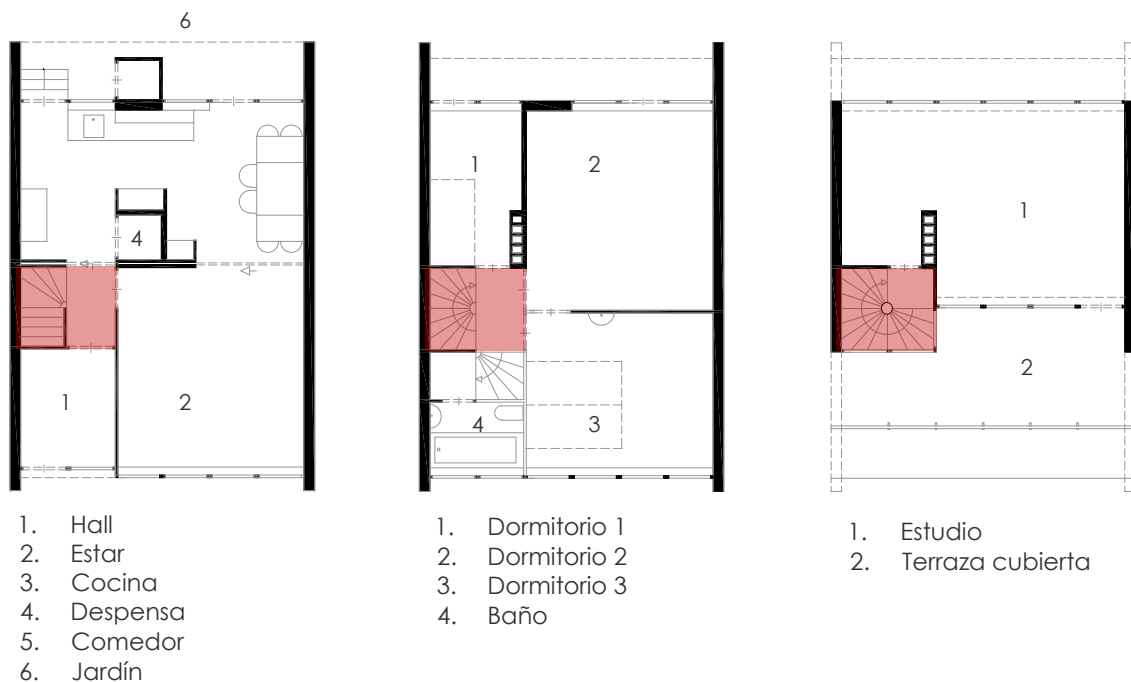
Planta Baja, Primera y Ático, se observa la distribución de los espacios en torno a la escalera.
